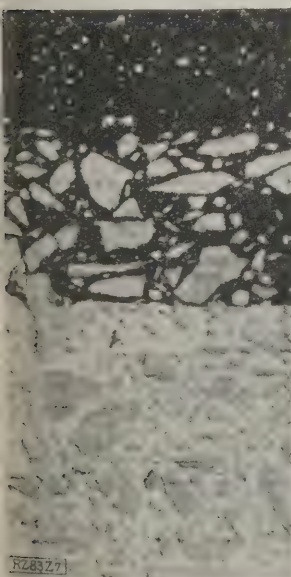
Schnitt durch Walzasphalt auf Zementbeton.
